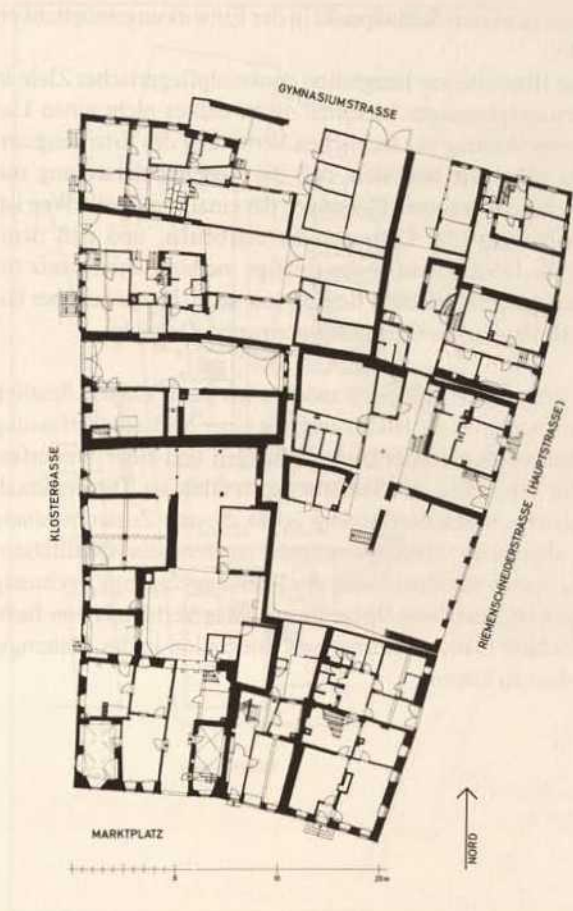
Münsterstadt, Lageplan des Sanierungsquartiers mit Eintragung der technisch verwertbaren Bebauung.
